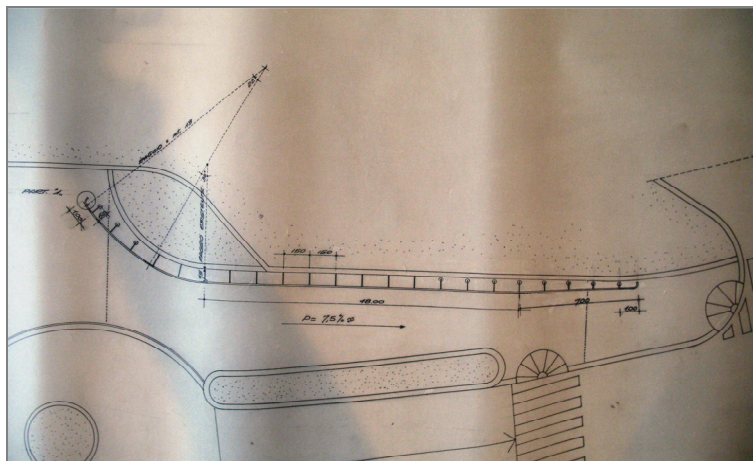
corrimano rampa ingresso principale – pianta (fonte CSAC – stralcio tav. 163, archivio n. 384-2)
